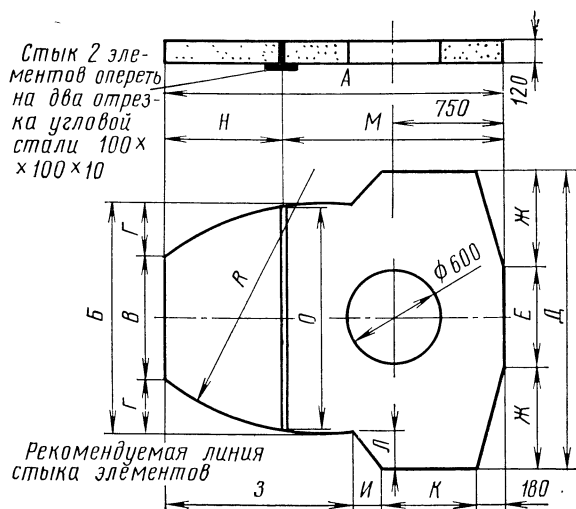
Сборное железобетонное перекрытие для разветвительных кирпичных колодцев типов ККС-3, ККС-4 и ККС-5
